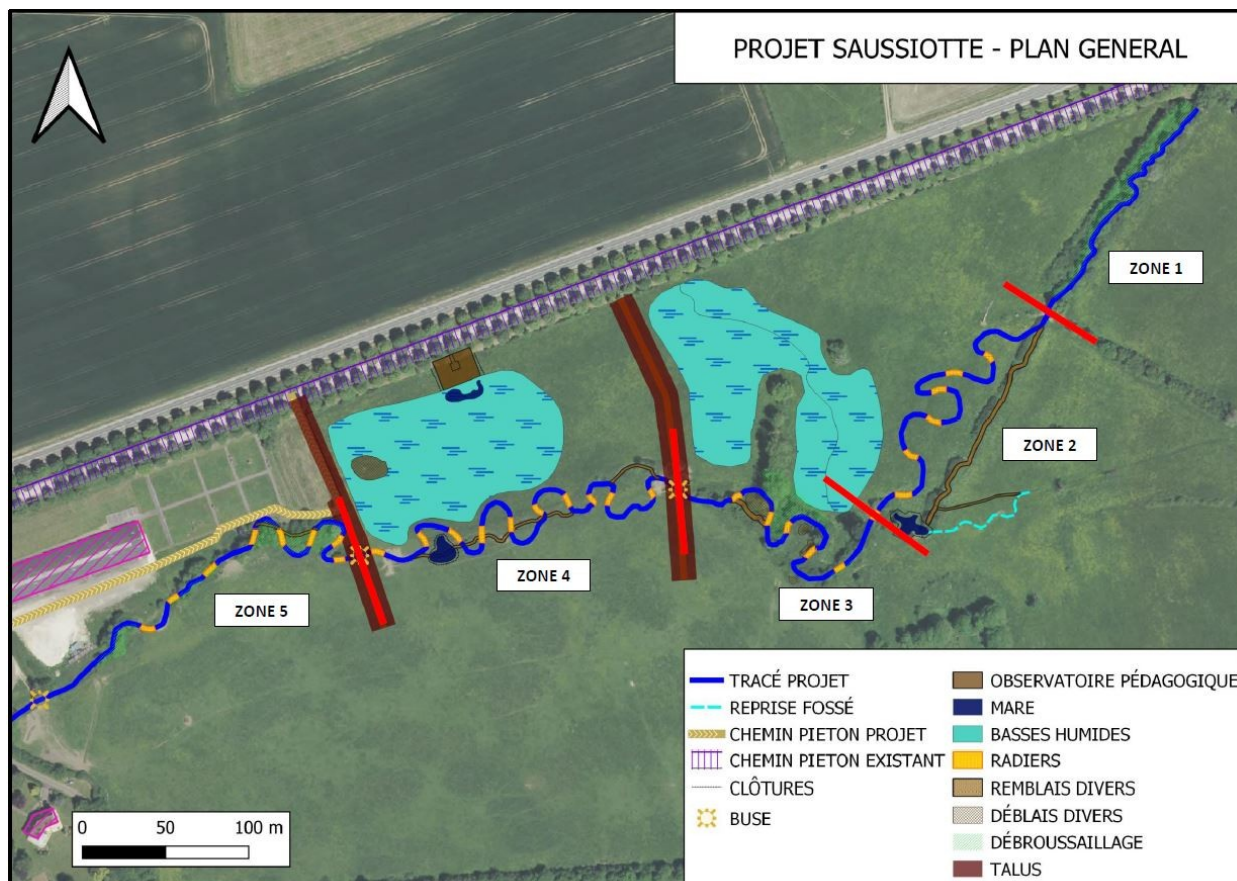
plan projet général du nouveau tracé et des actions prévues sur la zone projet (l'opération de recharge de matelas alluvial n'est pas représentée).
